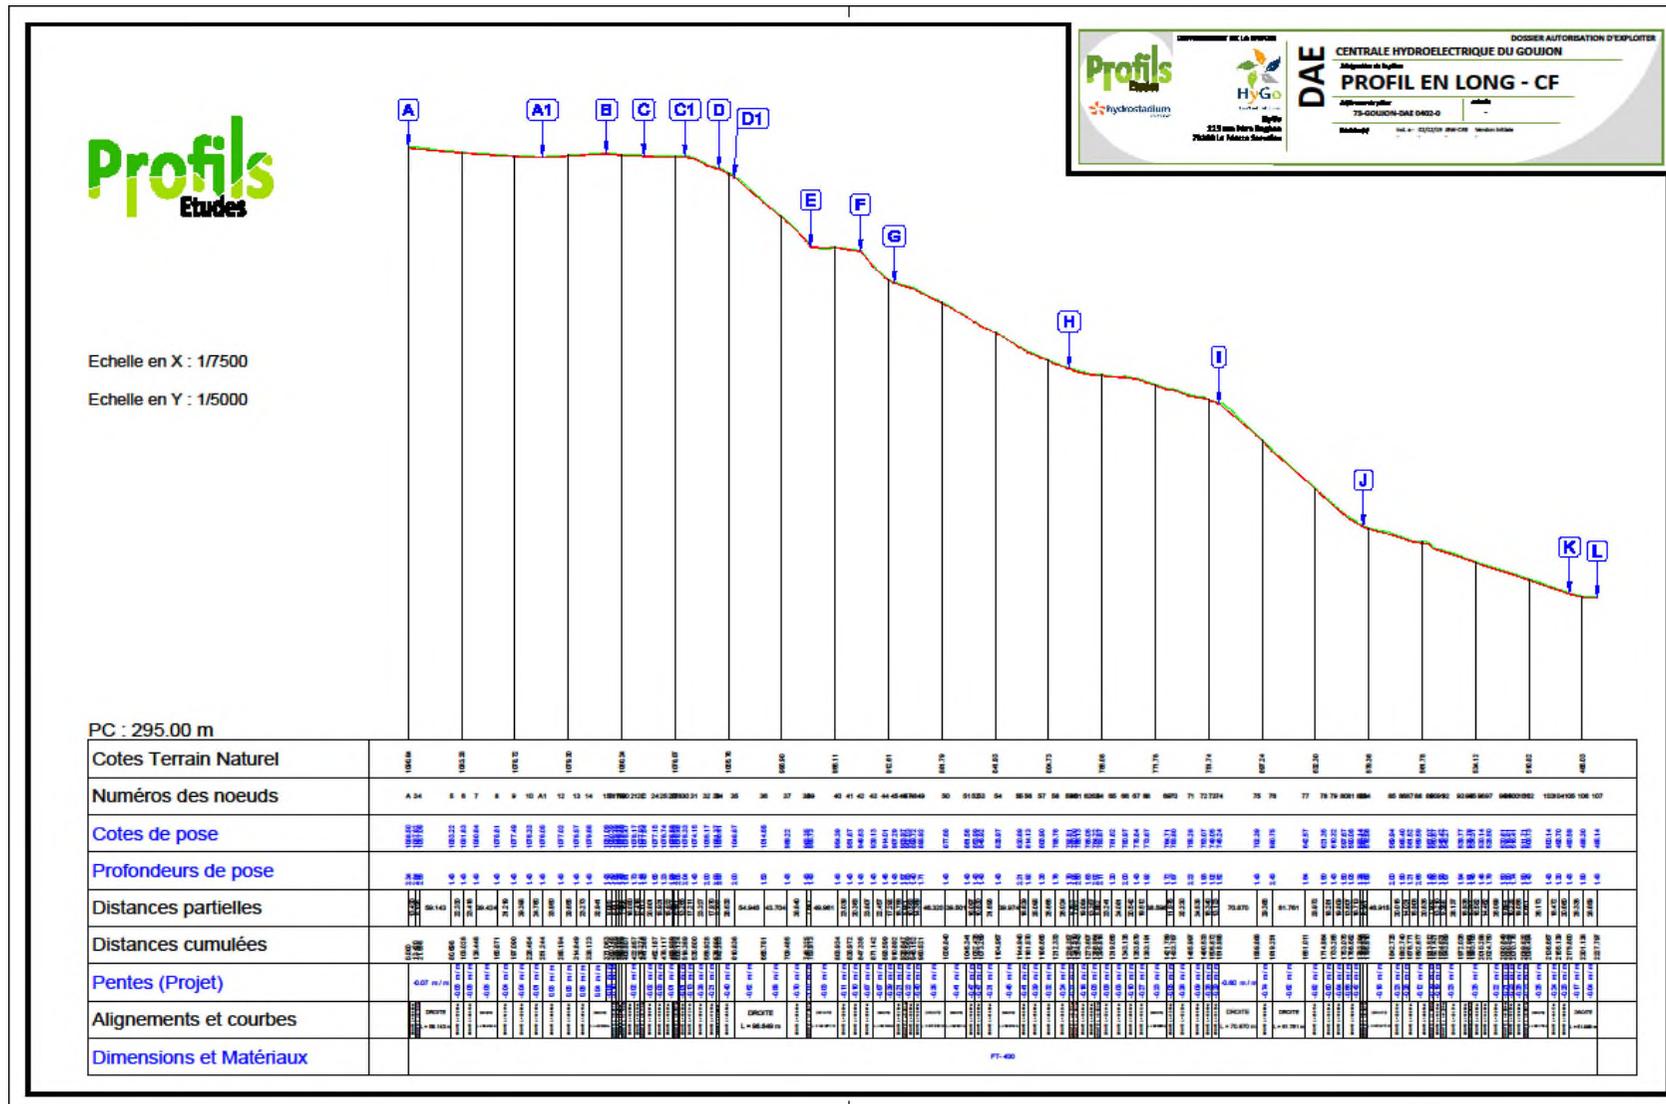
Profil en long de la conduite forcée (source : Profils études) (cf Annexe 5 page 432 : plan au format A3)
